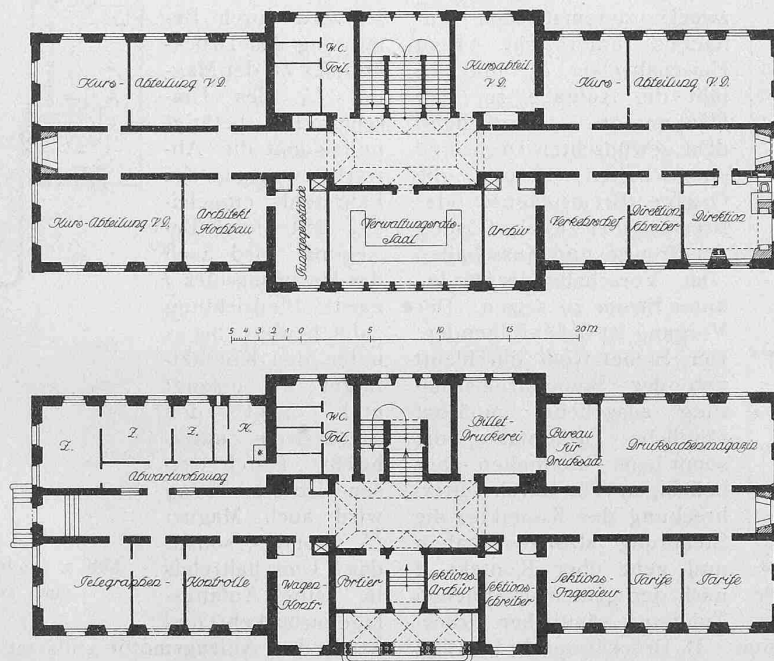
und 3. Grundrisse vom Erdgeschoss und I. Stock. — M. sstab 1 : 500.
